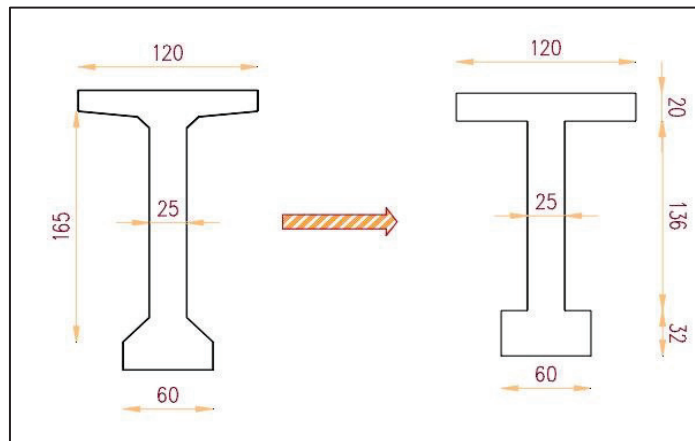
POUTRE REELLE/ POUTRE EQUIVALENTE.
